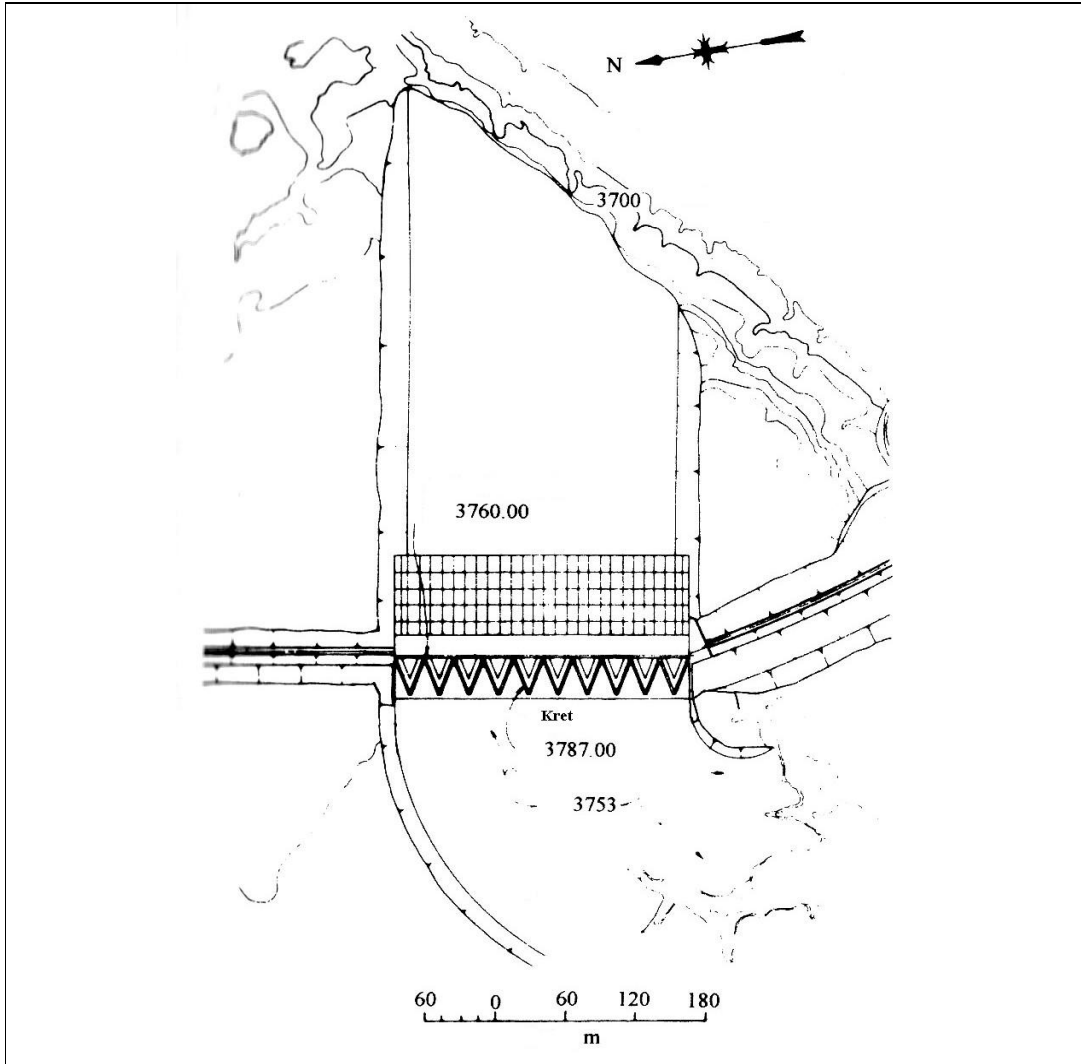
Hyrum Barajı Labirent Dolusavağı Yerleşim Planı ve Kesiti [52]
